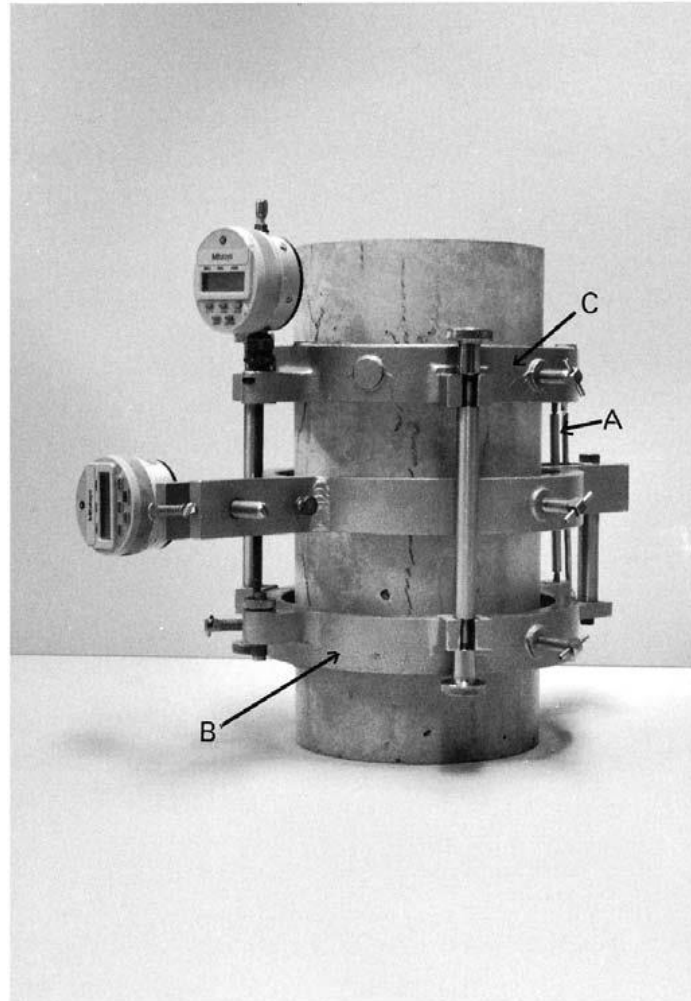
Compresometro en espécimen de cilindro. Fuente: ASTM C 469-14.
